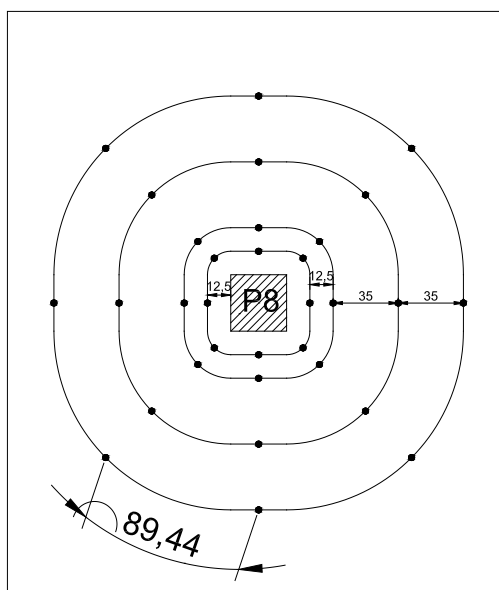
DISPOSIÇÃO DE ARMADURA DE PUNÇÃO PARA O PILAR P8 SEGUNDO EUROCODE 02:2010
